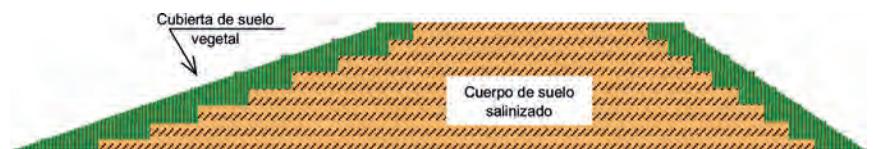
CONSTRUCCIÓN POR CAPAS
